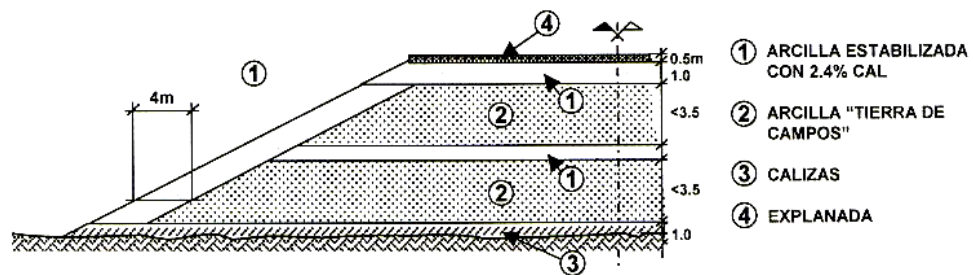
Sección propuesta para autovía en Tierra de Campos
